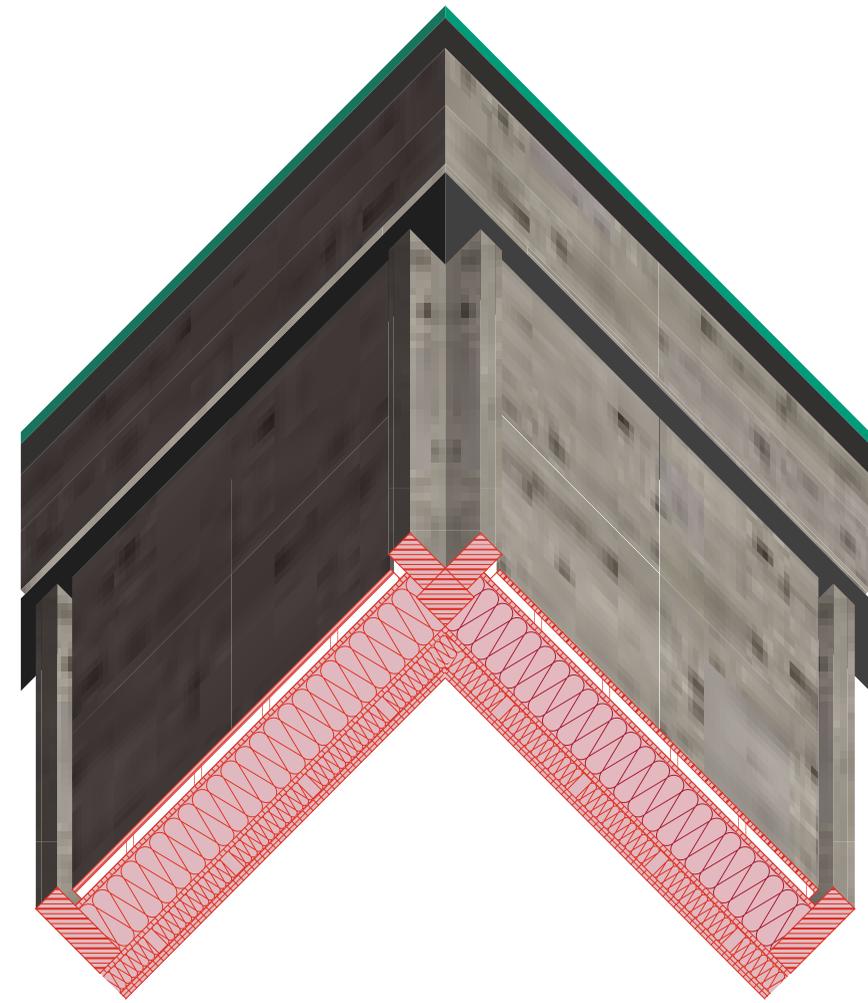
Axonometrische Schnitt Untersicht des Deckels mit Dachdetail, Eigene Darstellung, 2024.
